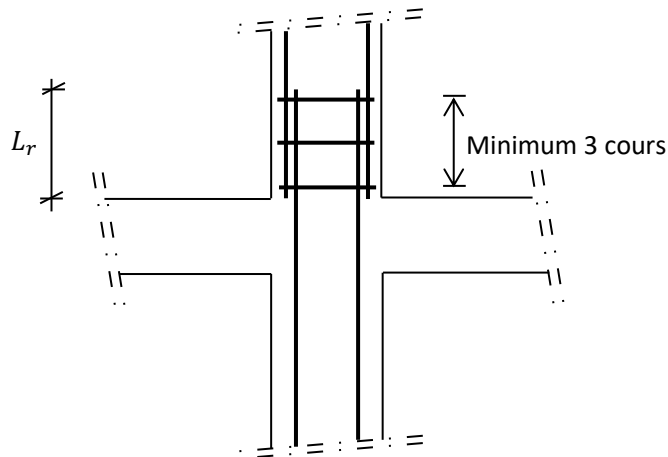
Les armatures transversales dans la zone de recouvrement
